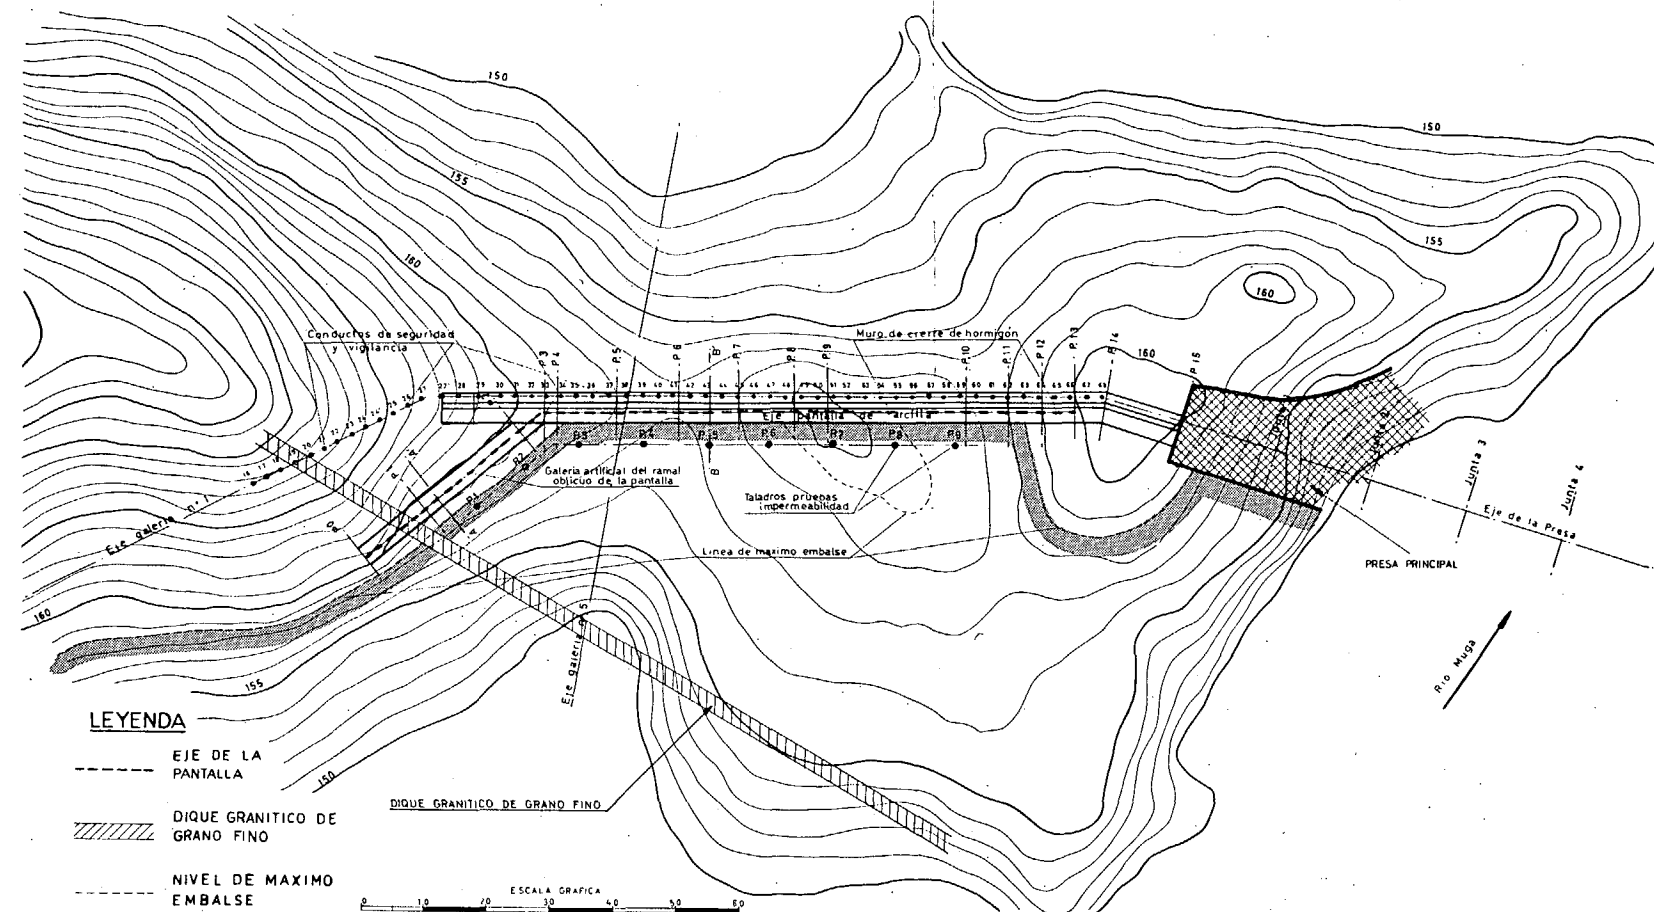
a — Sistema de impermeabilización del collado "Dels Fangots", en el pantano de Boadella, planta general.
